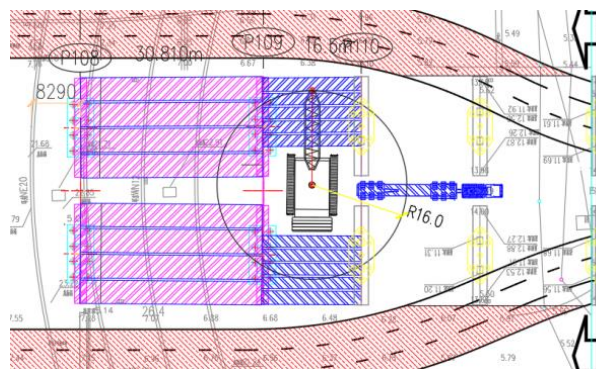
P109-110 双 T 梁履带吊吊装工况平面图
